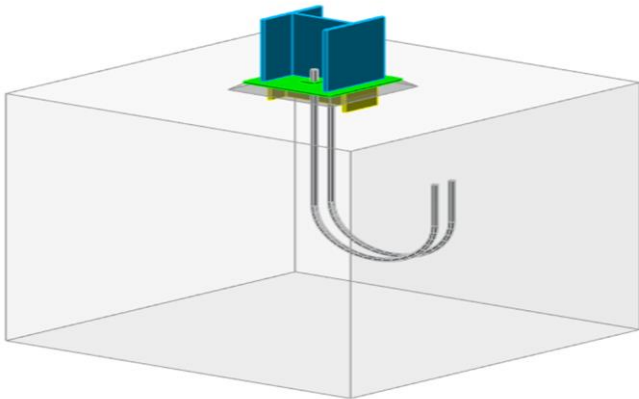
Vue de l'assemblage du pied de potelet en 3D.
